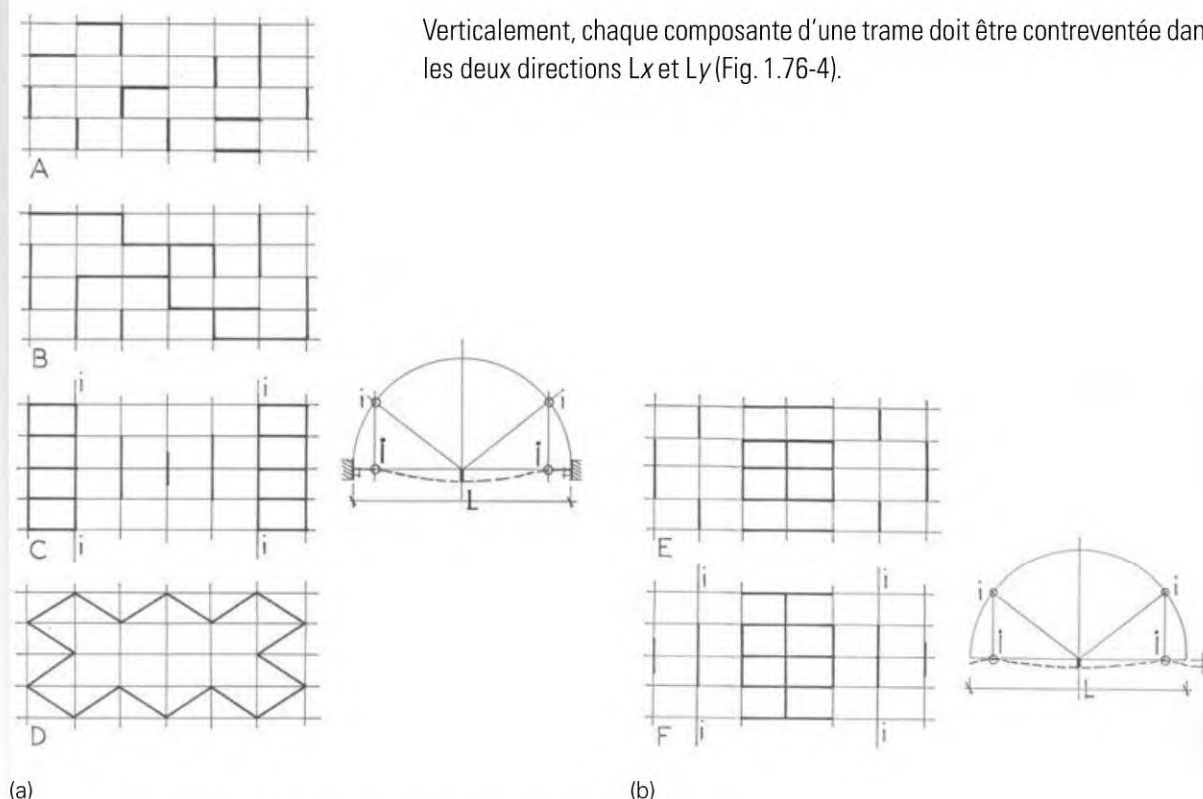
Dispositions possibles des panneaux de contreventement sur un plan trame.
